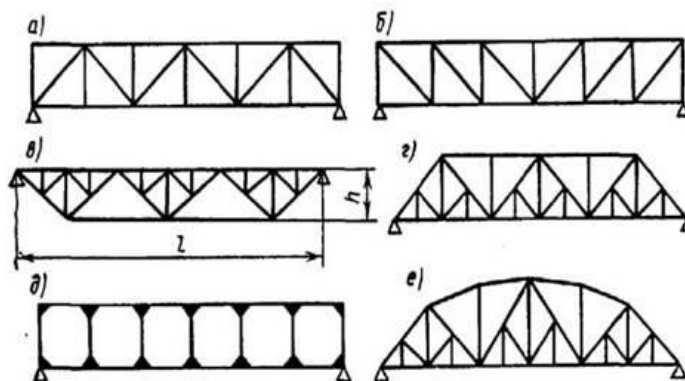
Схемы решеток а) – треугольная; б) – раскосная; в), г) – шпренгельная; д) – безраскосная; е) – с ломанным поясом
